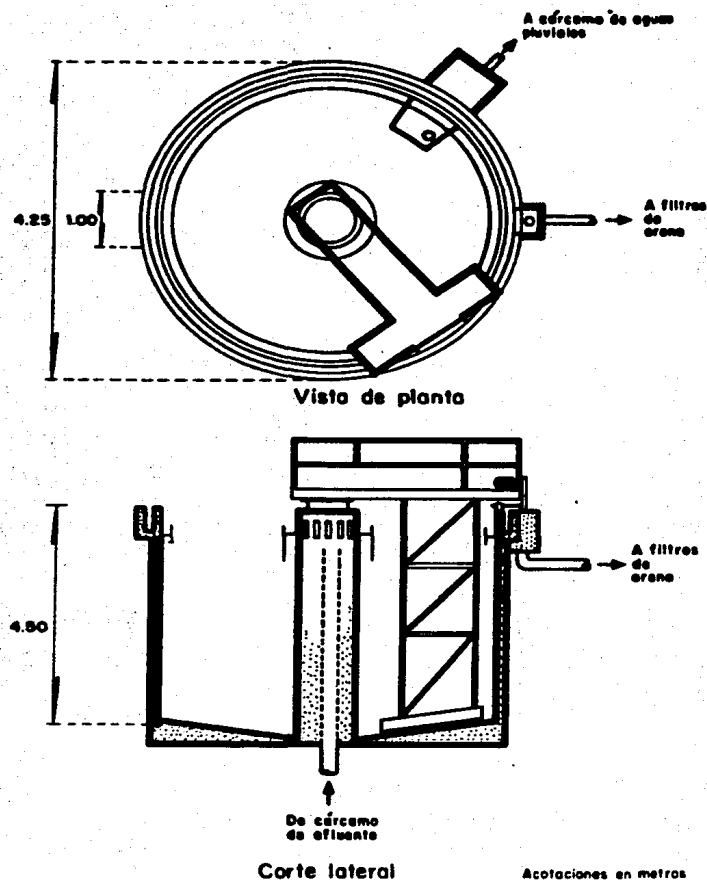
Sedimentador Secundario. Vista de Planta y Corte.
